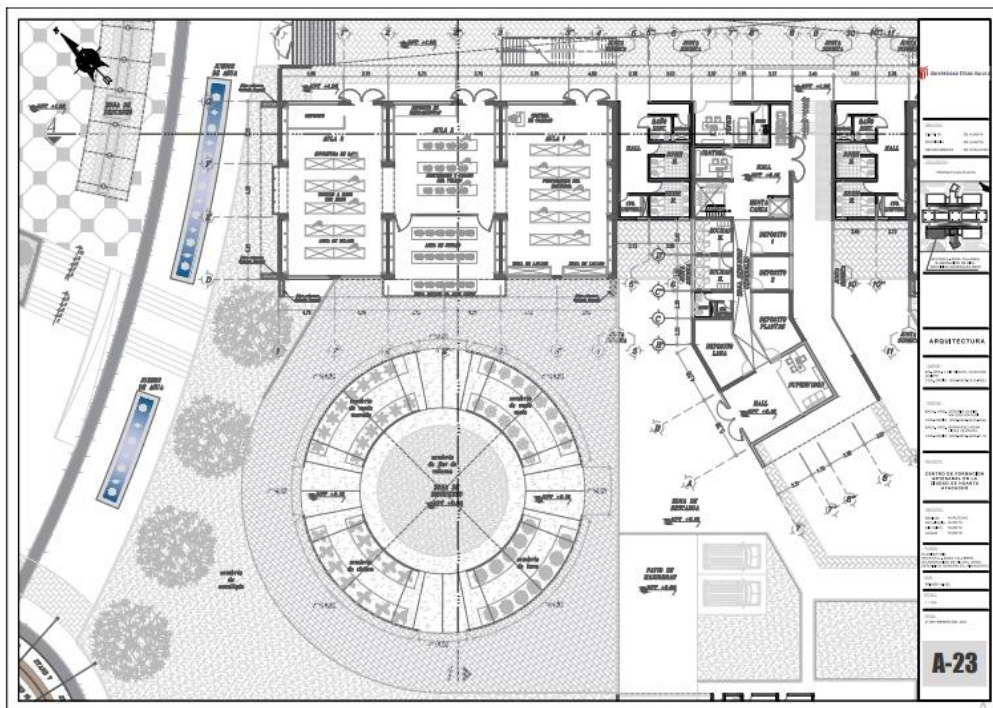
Planimetría del sector 6 ubicado en el piso 1. Escala 1/100.
